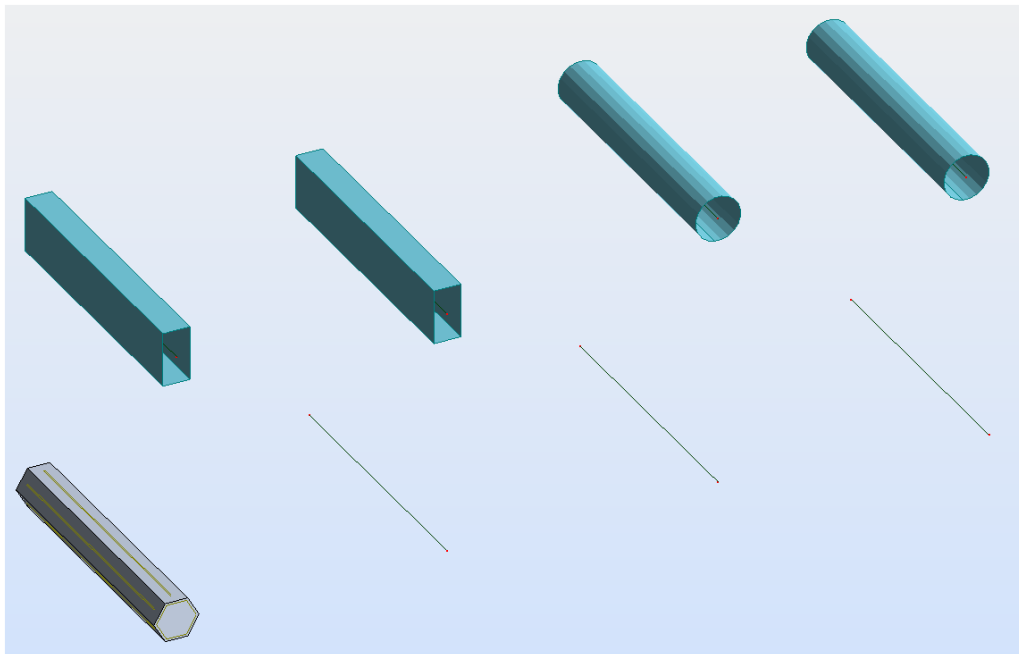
TS-ohjelmassa mallinnettiin kahdeksan pilaria. Linjalla yksi on tyypillisiä neliön ja pyöreän muotoisia betonipilareita. Linjalla 2 puolestaan profiloituaan erikoisempia muotoja; paitsi D2 pilari, joka on vino.
